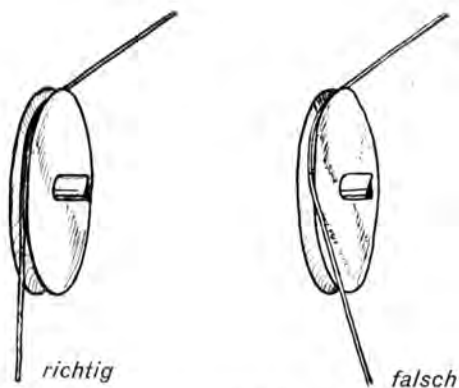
Richtiges und falsches Auflaufen von Kabeln auf Rollen.
